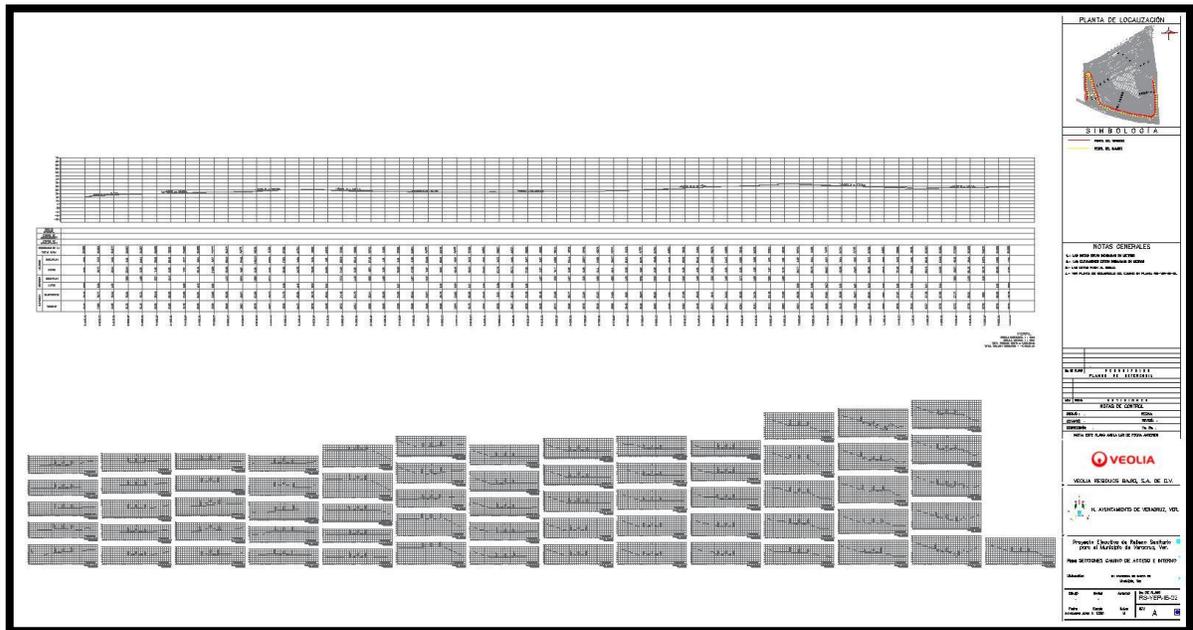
Plano de camino de acceso (desarrollo y secciones).
